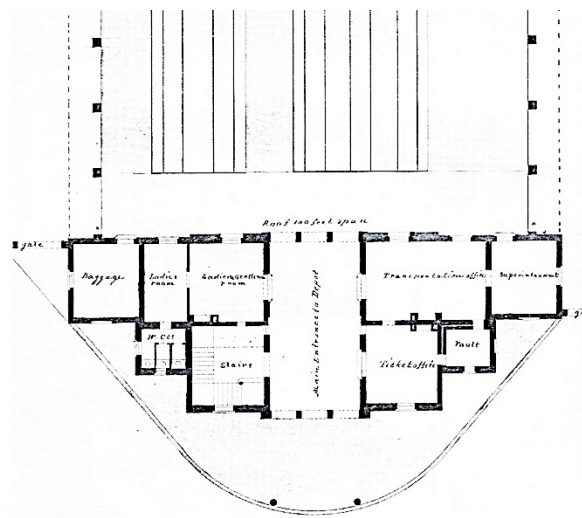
Grundriss Erdgeschoss (1848) o. M.
